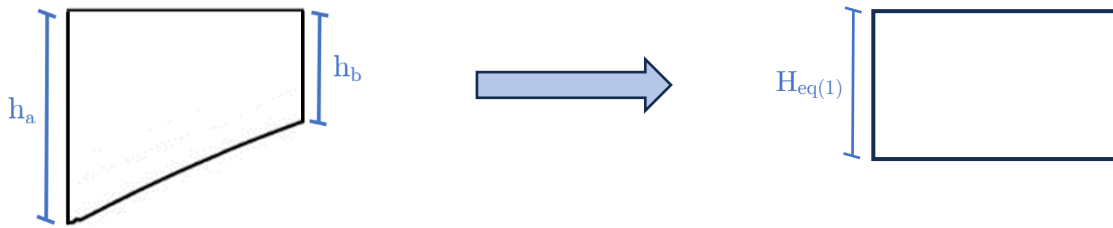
Hauteur équivalente de la section 1 de l'encorbellement
